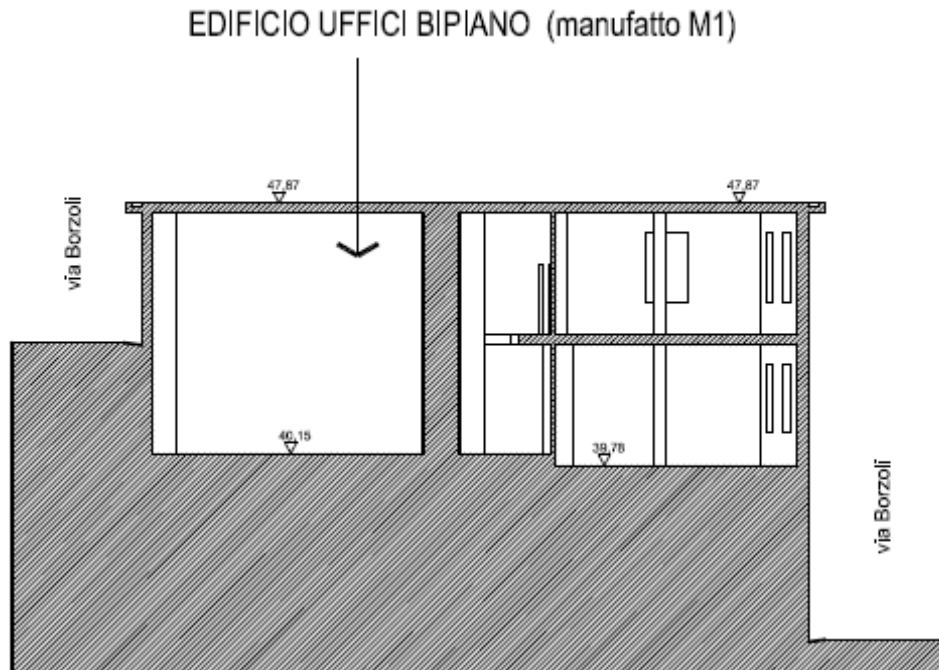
Sezione longitudinale cantiere in fase 2 (edificio M1)
